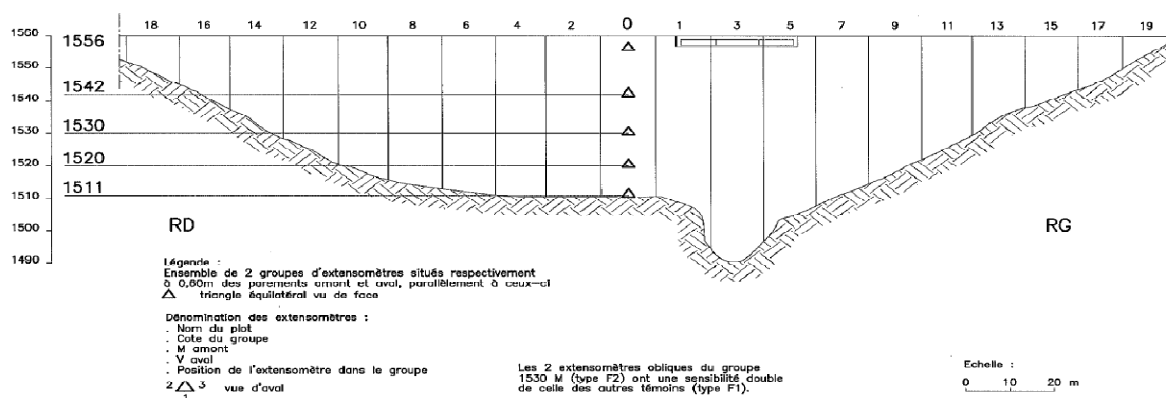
exemple de dispositif d'extensomètres d'un barrage voûte
